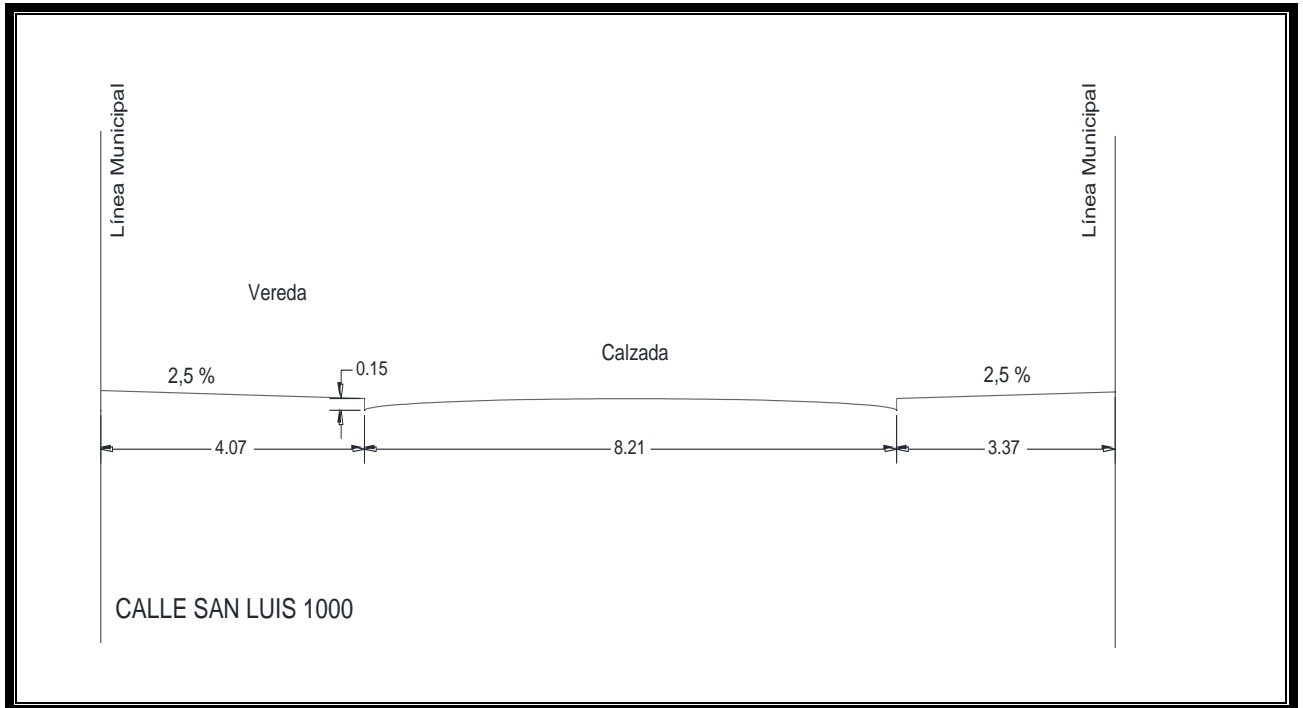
Sección transversal tipo de calles pavimentadas (fuente: elaboración propia).
